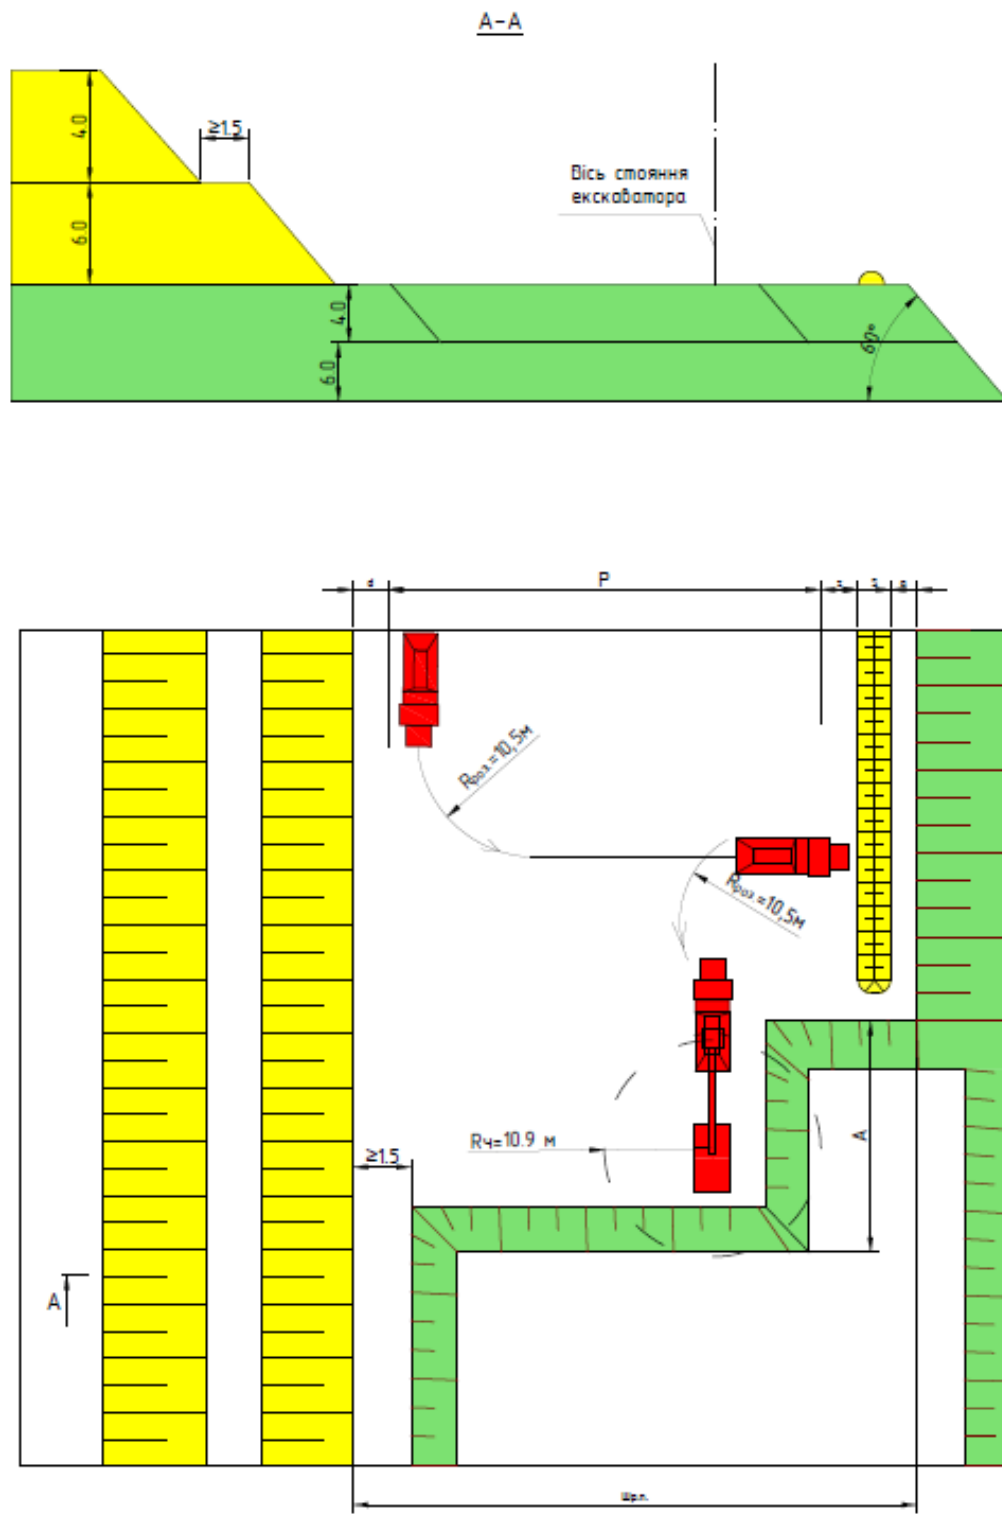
Паспорт роботи гірничо-транспортного устаткування на розробці корисної копалини
